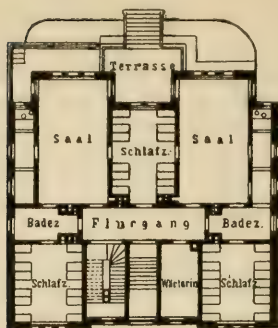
Olga-Krippe von Stuttgart. Grundriss des Erdgeschosses.
